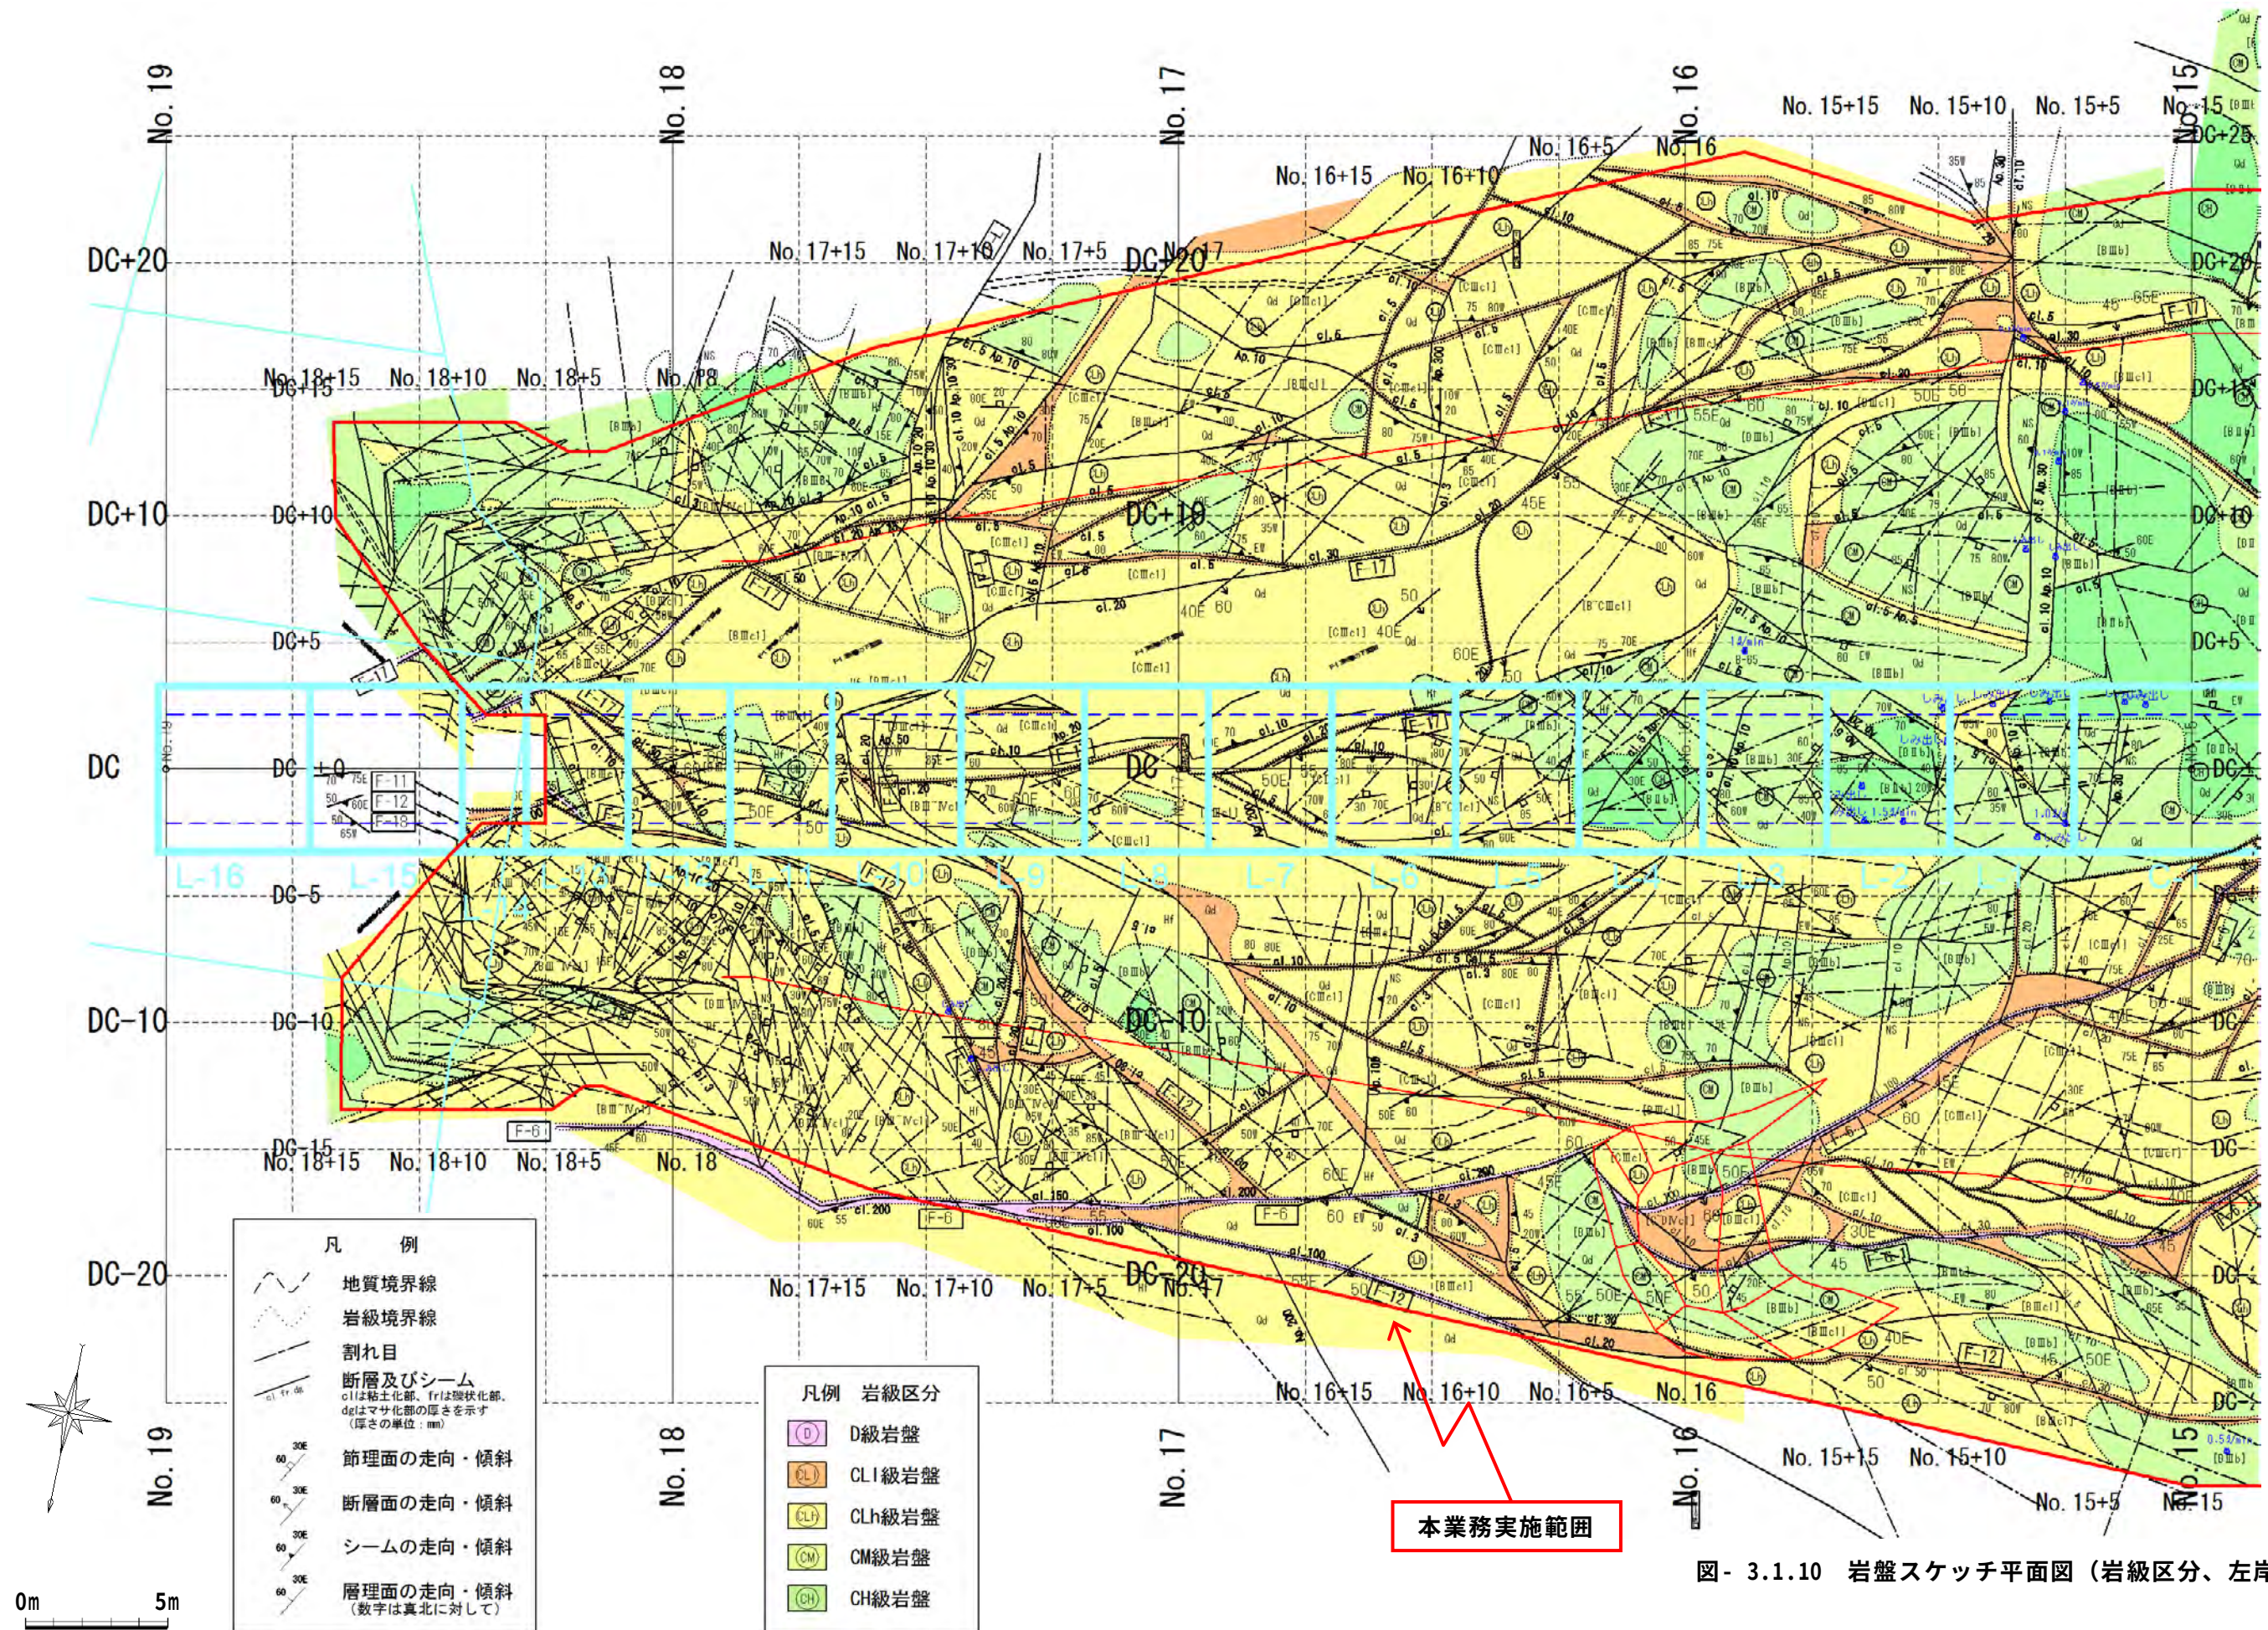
岩盤スケッチ平面図 (岩級区分、左岸部)
